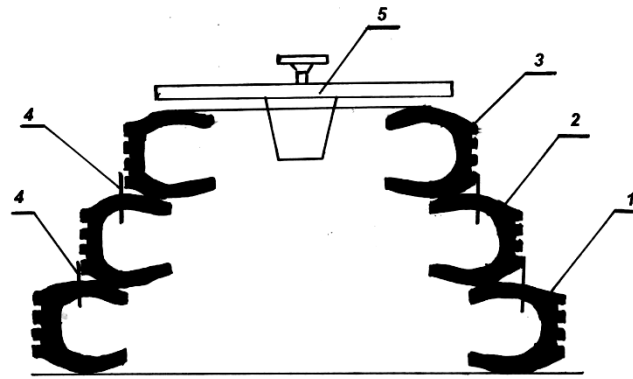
Несъемная опалубка круглого монолитного фундамента
